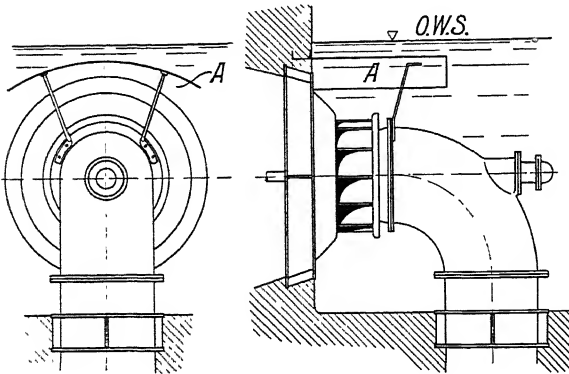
Turbine mit Schild gegen Trichterbildung.
